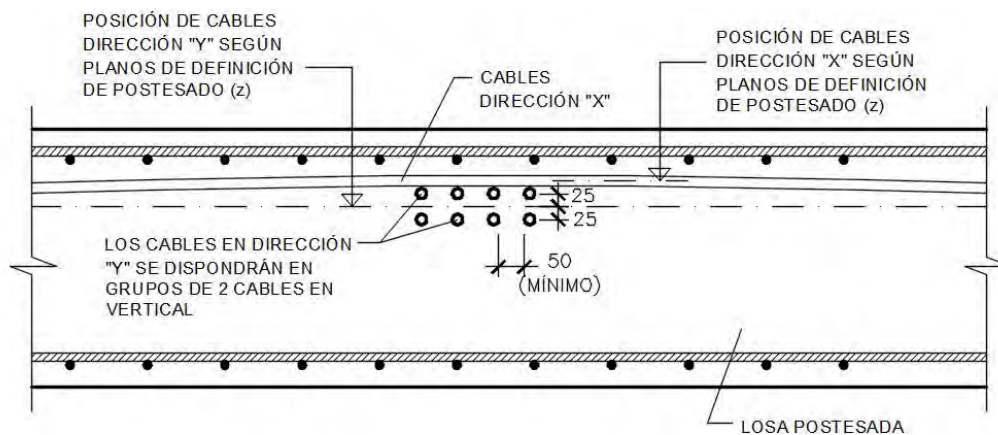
Detalle tipo de disposición de cables de pretensado en losa de Planta Primera.
